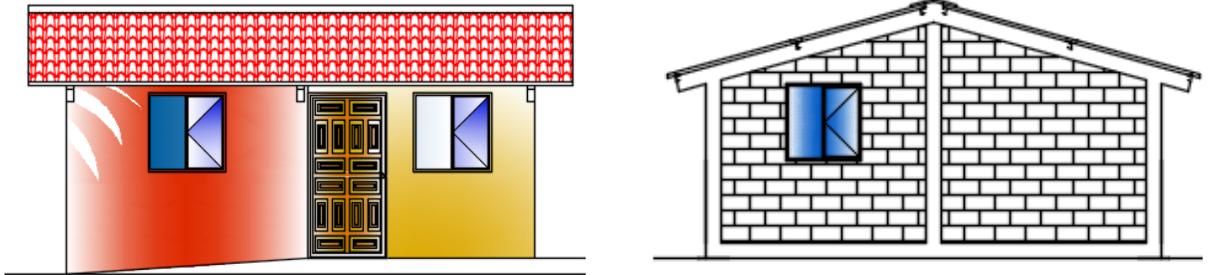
Fachada frontal y lateral vivienda MIDUVI año 2012.
